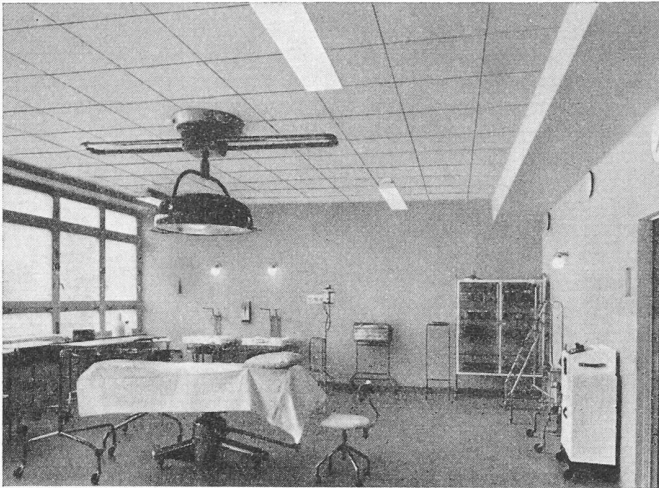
In bestehenden Operationssaal nachträglich eingebaute Frenger-Decke, die ein sehr rasches Aufheizen ermöglicht und leicht abwaschbar ist.
